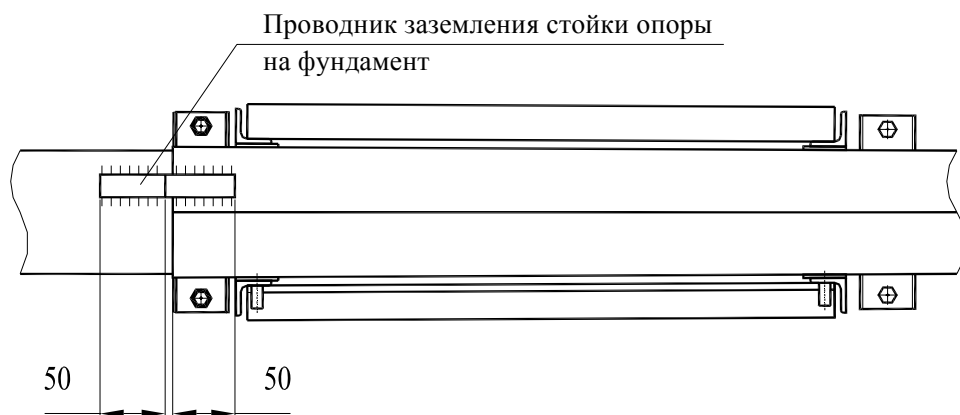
Заземление стойки опоры на трубу фундамента
